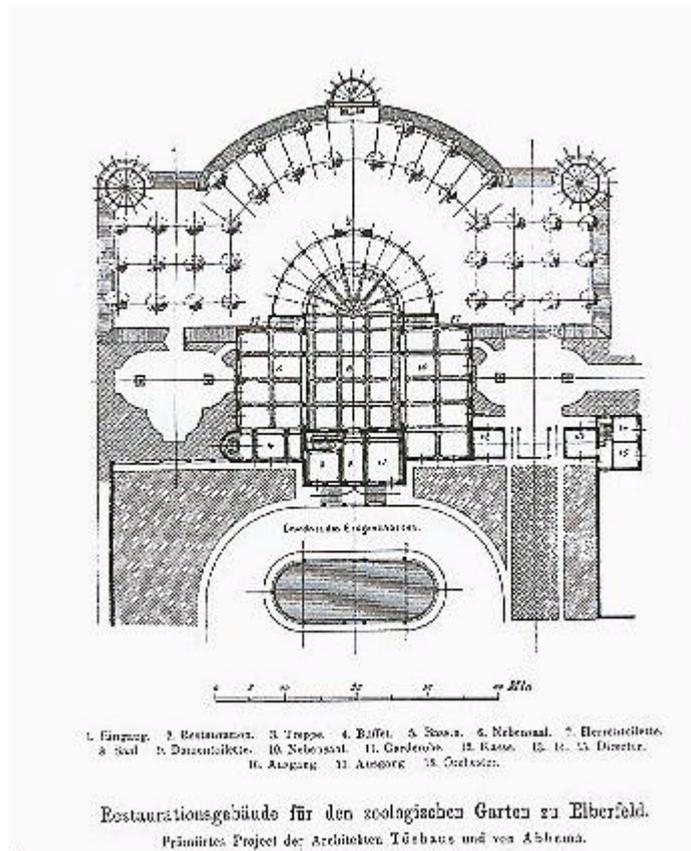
Grundriß des Restaurationsgebäudes, Entwurf der Architekten Tüshaus und Abbema
